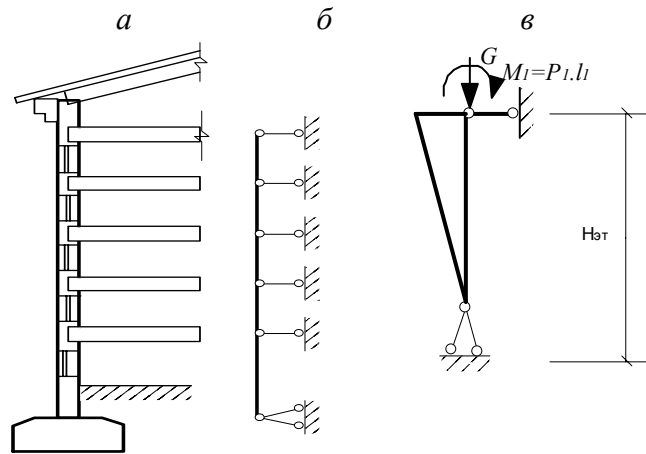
Конструктивна (а) і розрахункова схеми (б, в) безкаркасної будівлі с цегельними стінами
